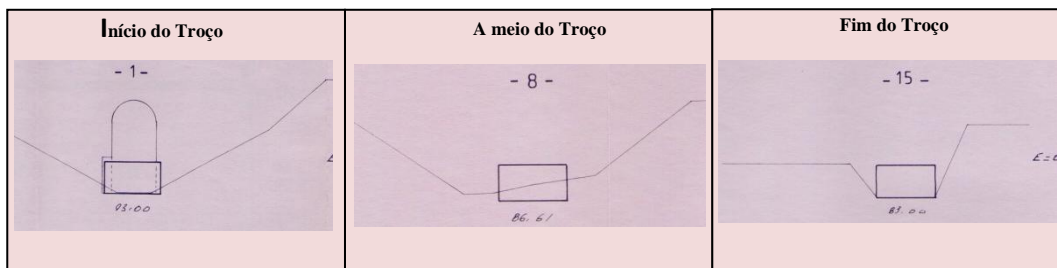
Perfis transversais, antes e após o projeto. Área compreendida entre a ponte do matadouro até ao início da secção anteriormente coberta.
